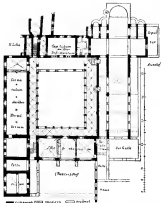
Grundriß des Klosters mit Einzeichnung der romanischen Kirche.
